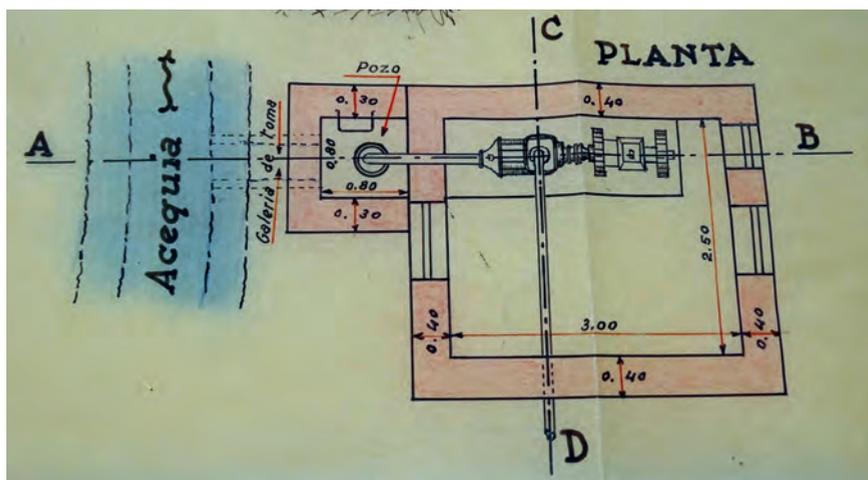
Sección de la planta de la instalación proyectada. Foto de los autores. ACHS
